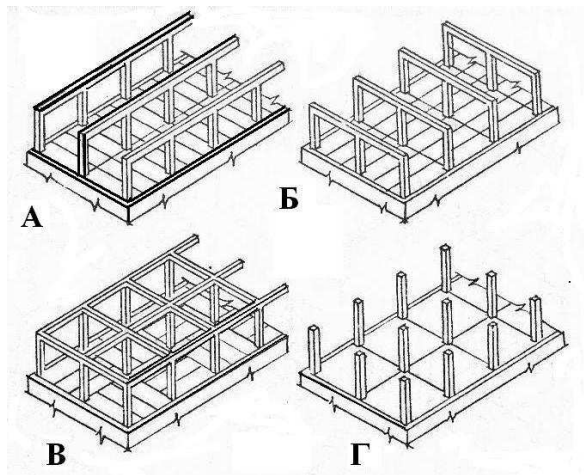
Каркасна схема будівель з повним каркасом:
